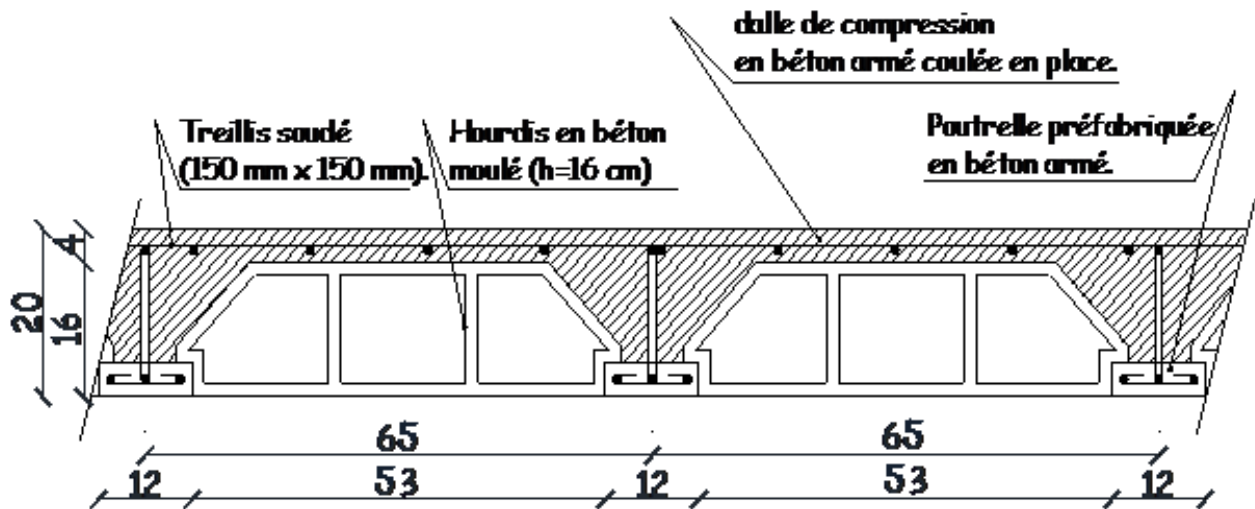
Plancher semi préfabriqué en béton armé (poutrelles et hourdis)
